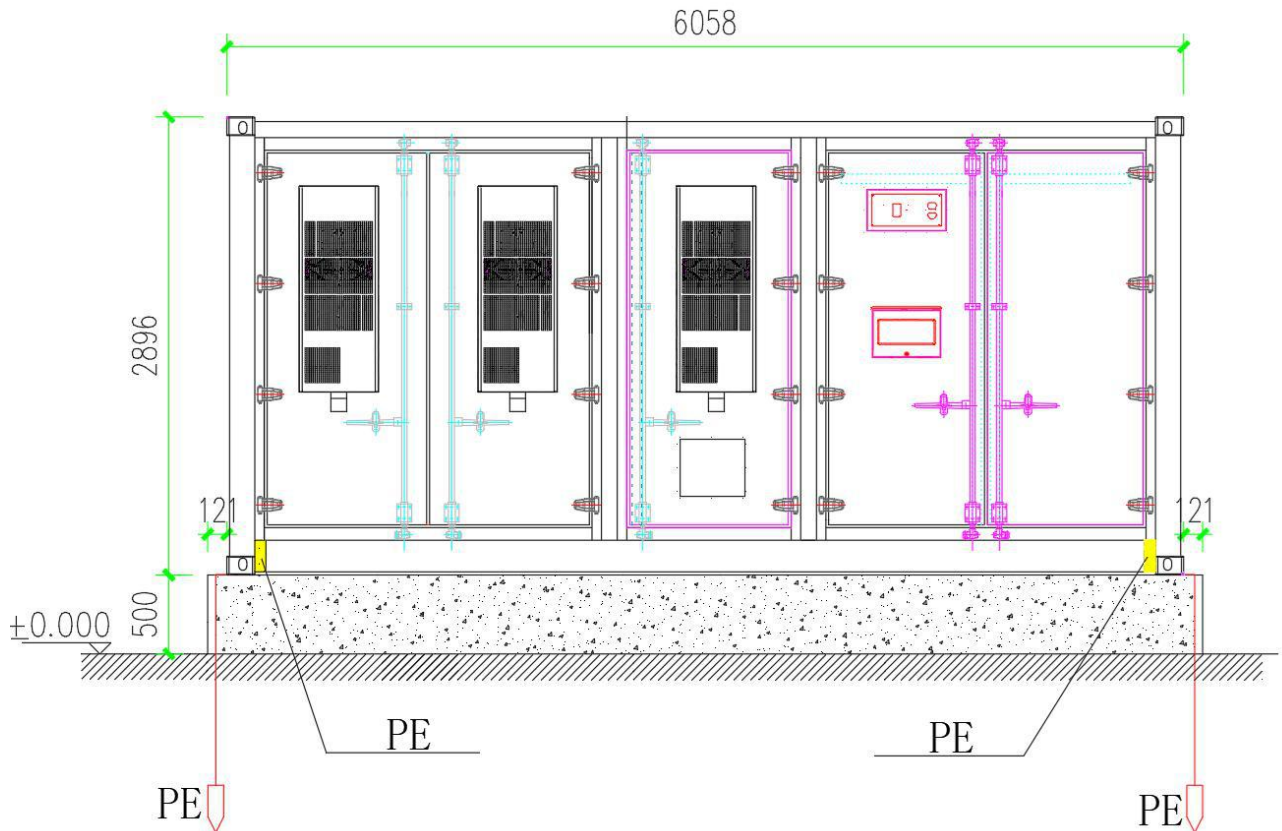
A 地面地基尺寸与要求示意图 正面图
